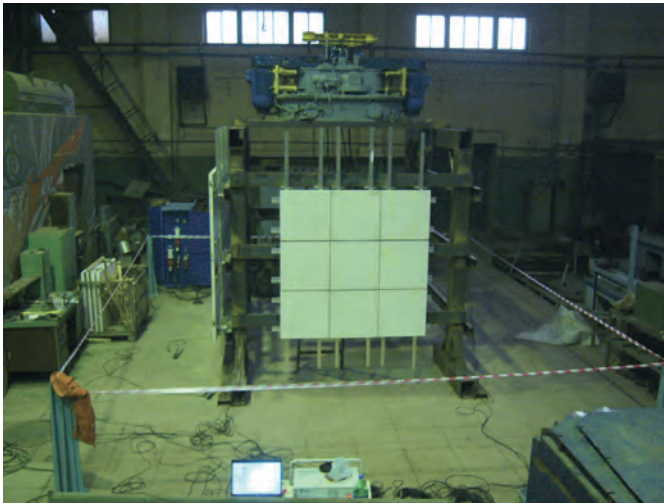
Испытания фрагмента фасадной системы «БВМ-Фасаденбау», Москва, 2009
